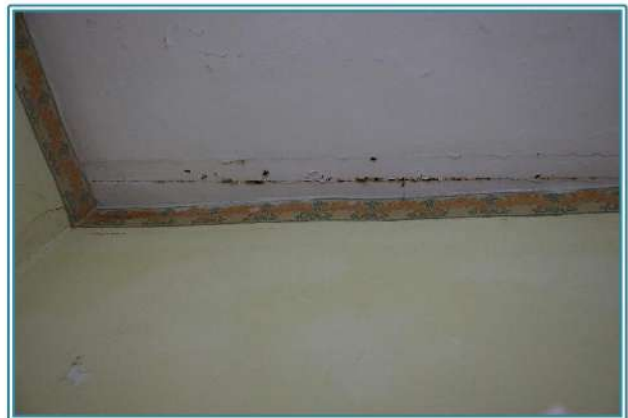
Segni di ammaloramento sul soffitto e sulle pareti nella camera2
